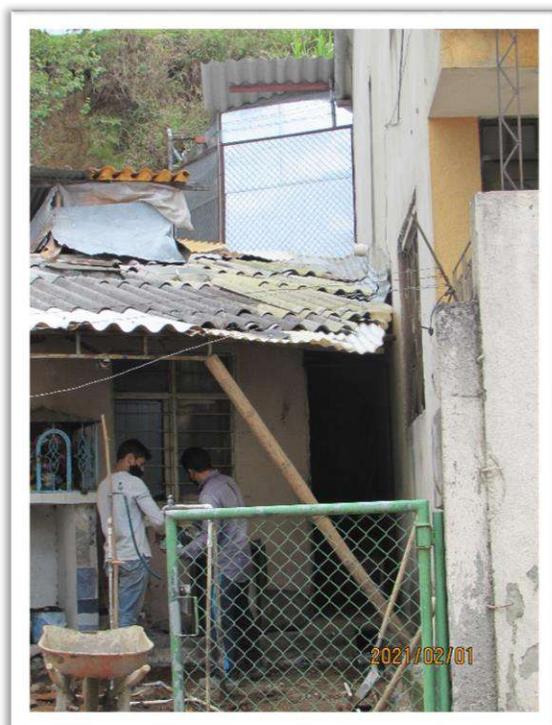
PASILLO CUBIERTO PREDIO SIRVIENTE
